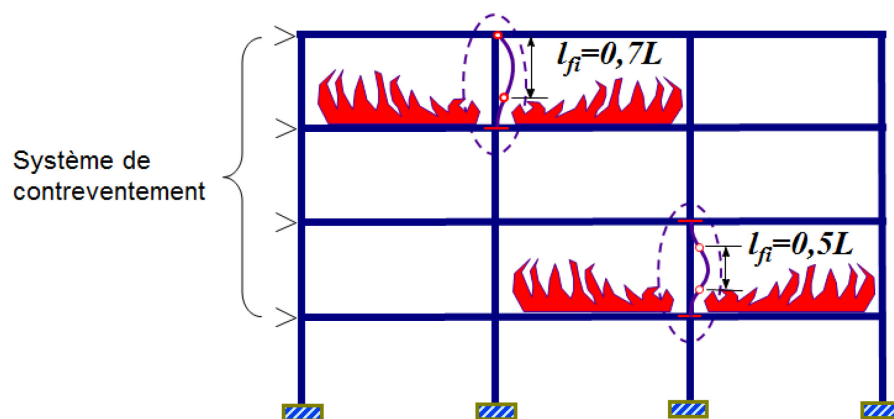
Longueurs de flambement en situation d'incendie des poteaux d'ossatures contreventées
